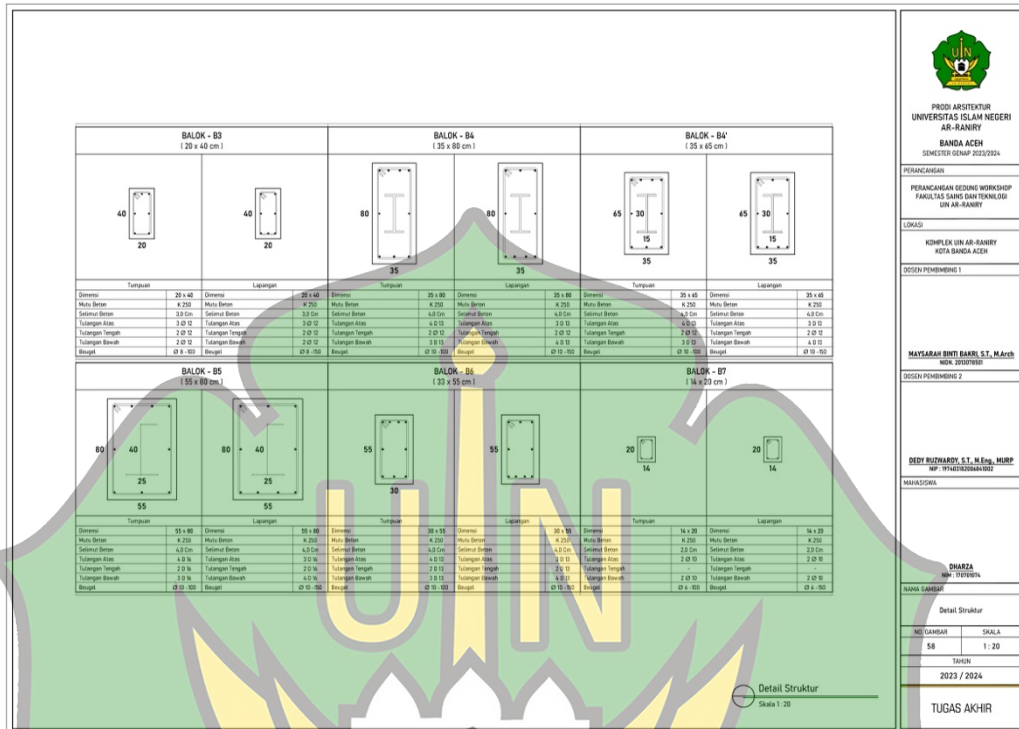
Detail Penulangan Balok dan Plat Lantai (Sumber: Dokumen Pribadi)
